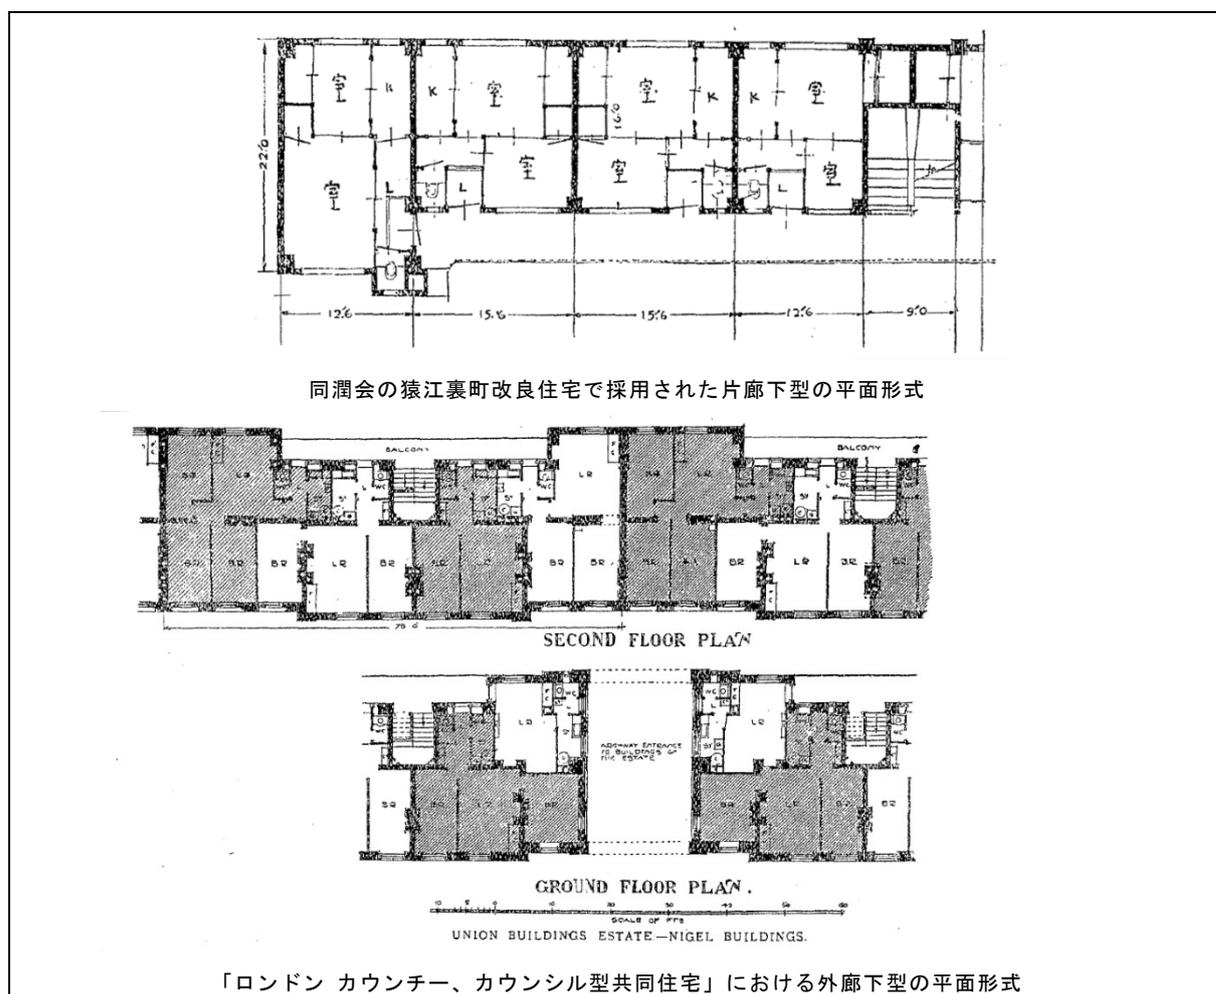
中村の講演「我国住宅政策の近況」で示された改良住宅の平面図
